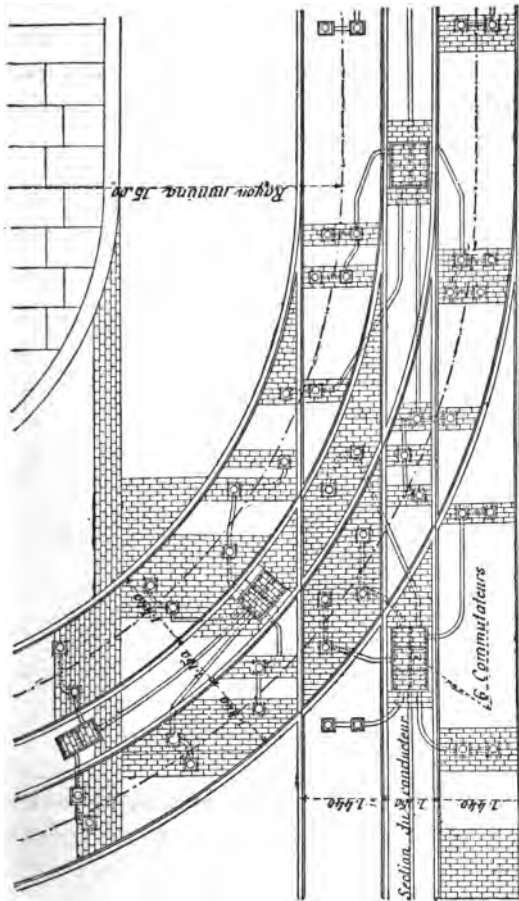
Vue en plan d'un aiguillage (système Westinghouse).
